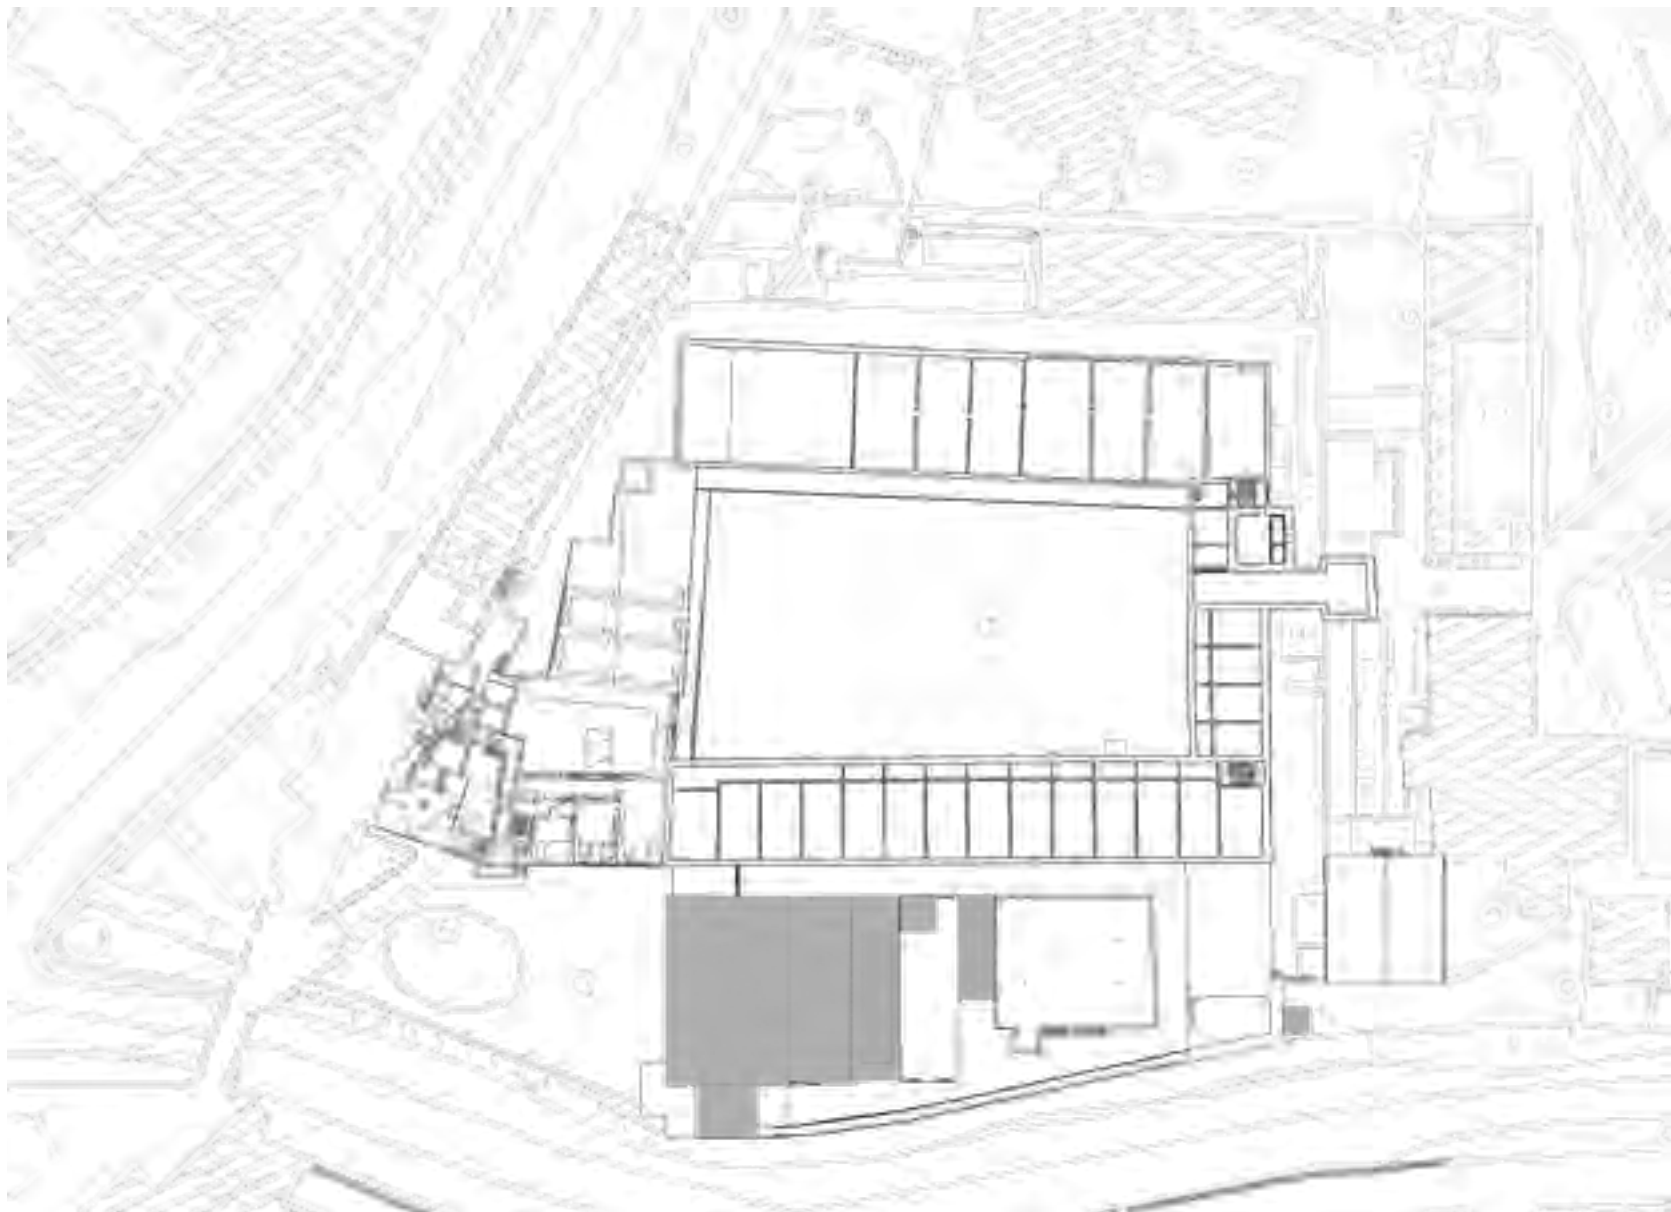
Planimetria attuale del castello carrarese, piano secondo.
